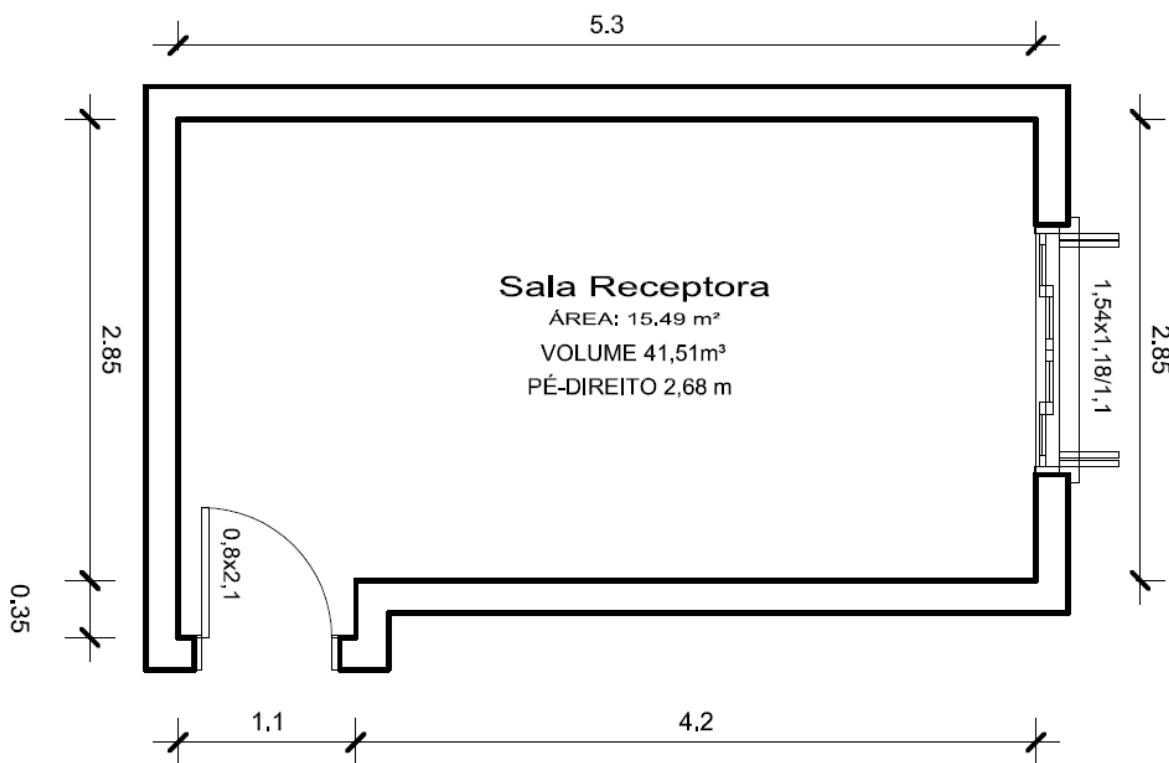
Planta baixa da sala receptora, tipologia de laje: Pré-Laje.
